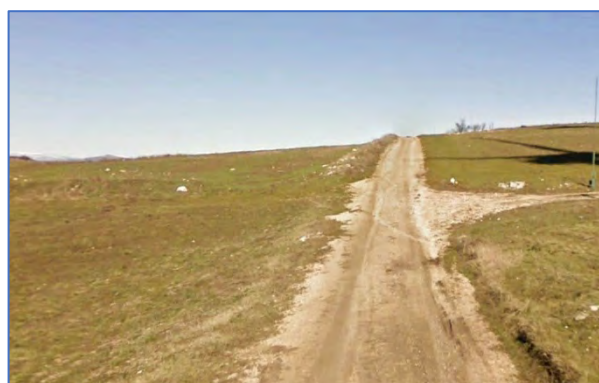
Cavidotto di collegamento tra SMC04-SMC05 vista da sud
